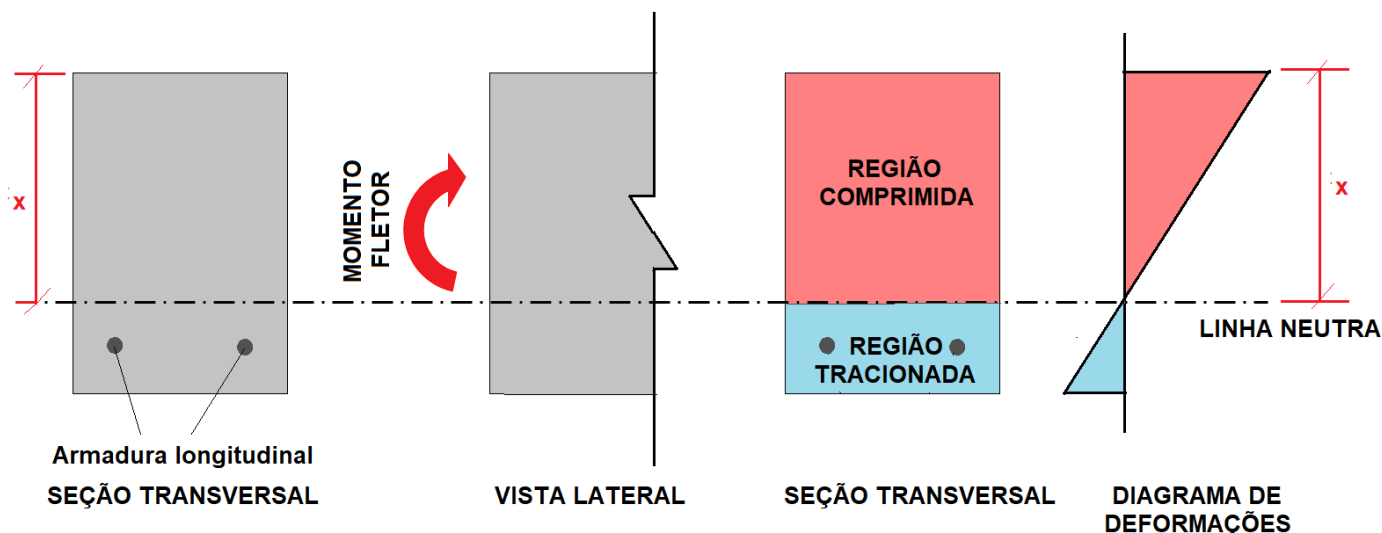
Posição da linha neutra em seção de concreto submetida a flexão.
